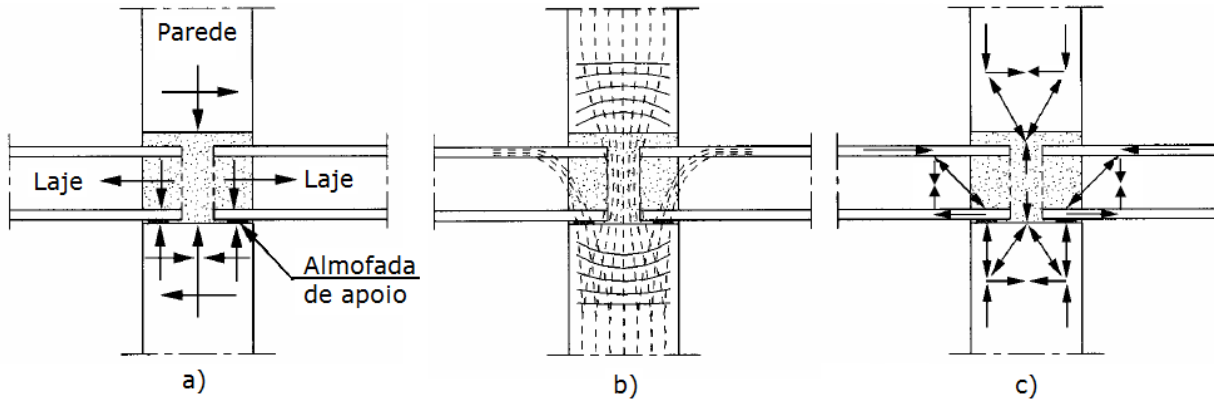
Ligação parede-laje-parede. [Fonte: FIB (2008)]
